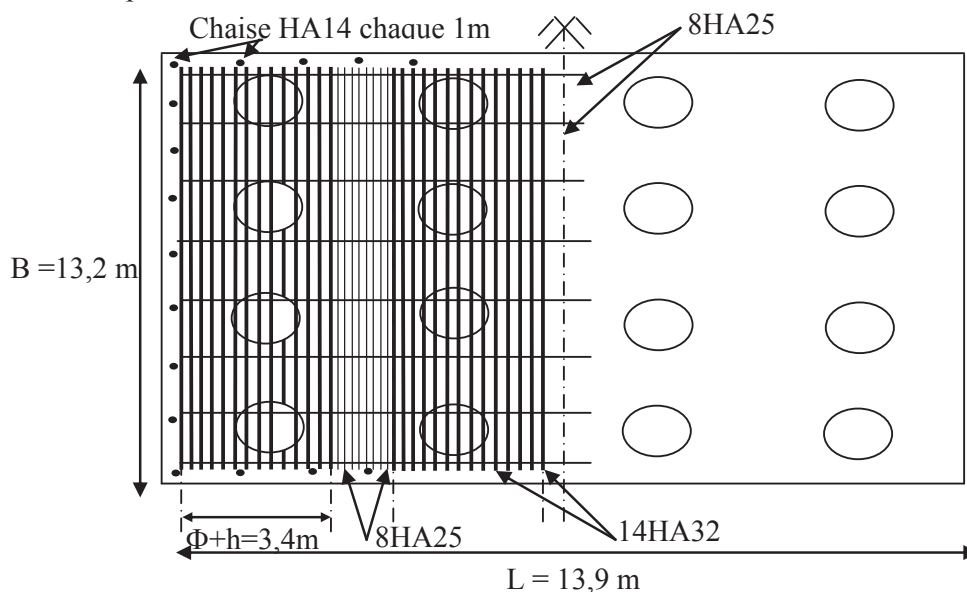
Ferrailage de la semelle (Nappe inférieure).
